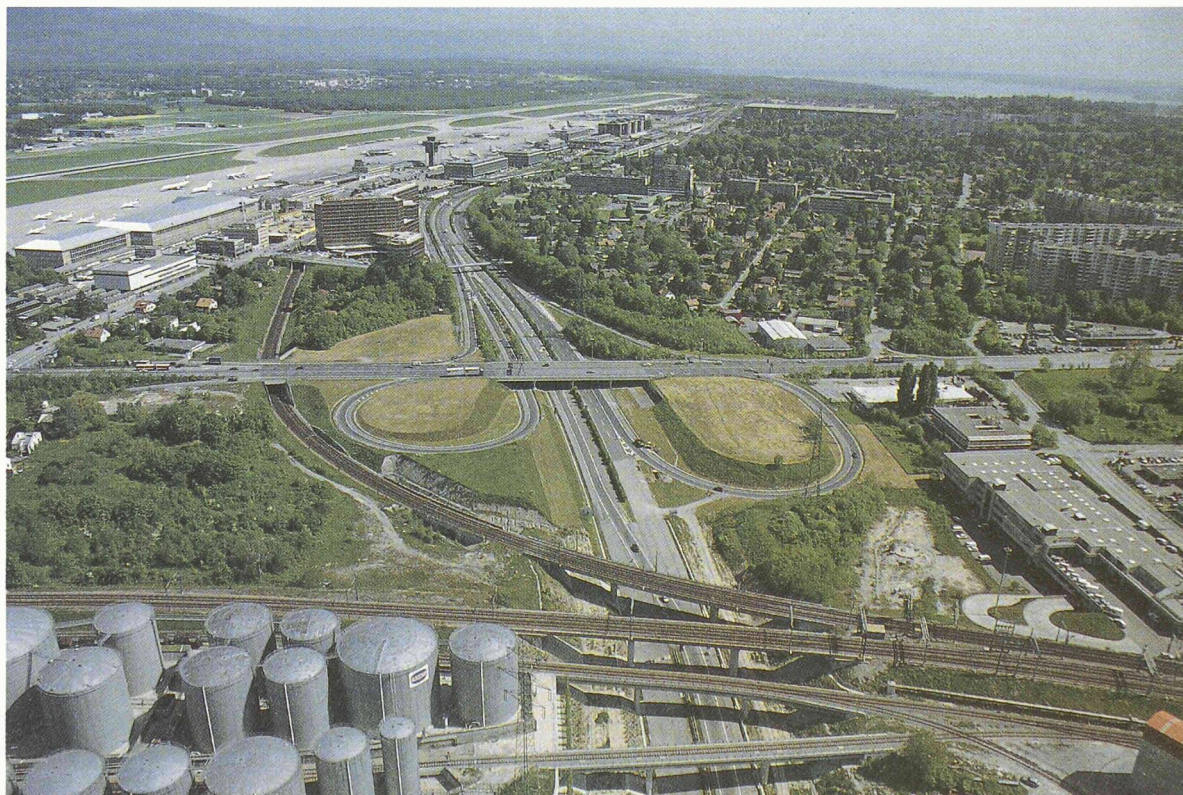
L'aéroport de Genève-Cointrin et l'autoroute de contournement. Au centre, la demi-jonction de la route de Meyrin. Au premier plan, on distingue quatre ponts ferroviaires dont deux (OA 411 et 412) construits dans le cadre de la section 7, deux autres (OA 412 et 413) dans celui de la section 8.
